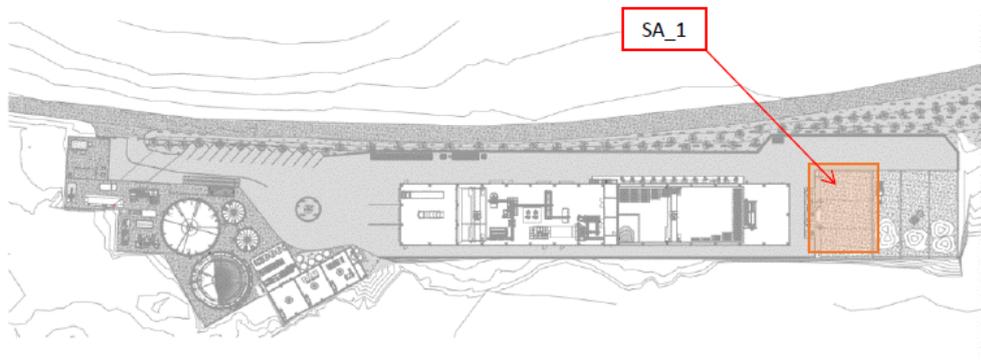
Planimetria con individuazione della sorgente emissiva da biofiltro e essiccatore
